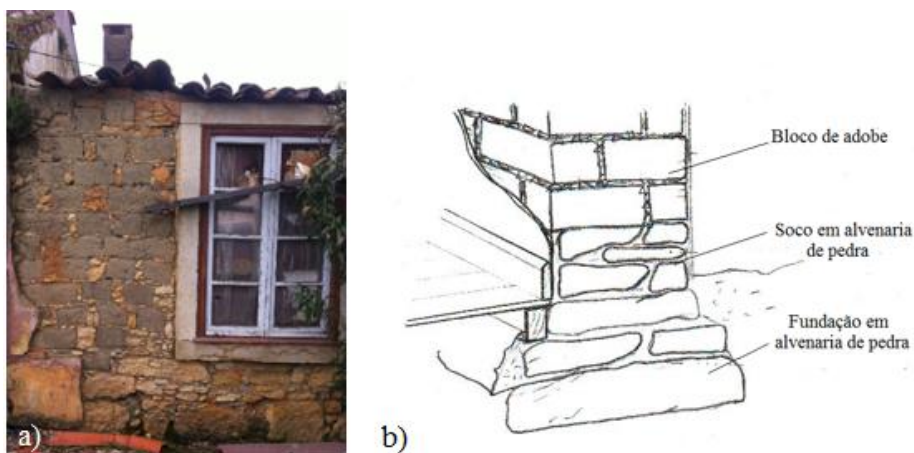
a) Soco executado em alvenaria de pedra calcária, b) Pormenor de fundação em pedra de uma construção em adobe [6]
